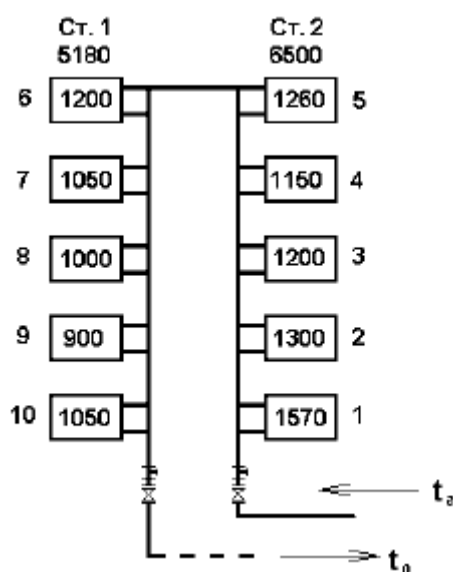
Схема распределения тепловых нагрузок на стояке 1
